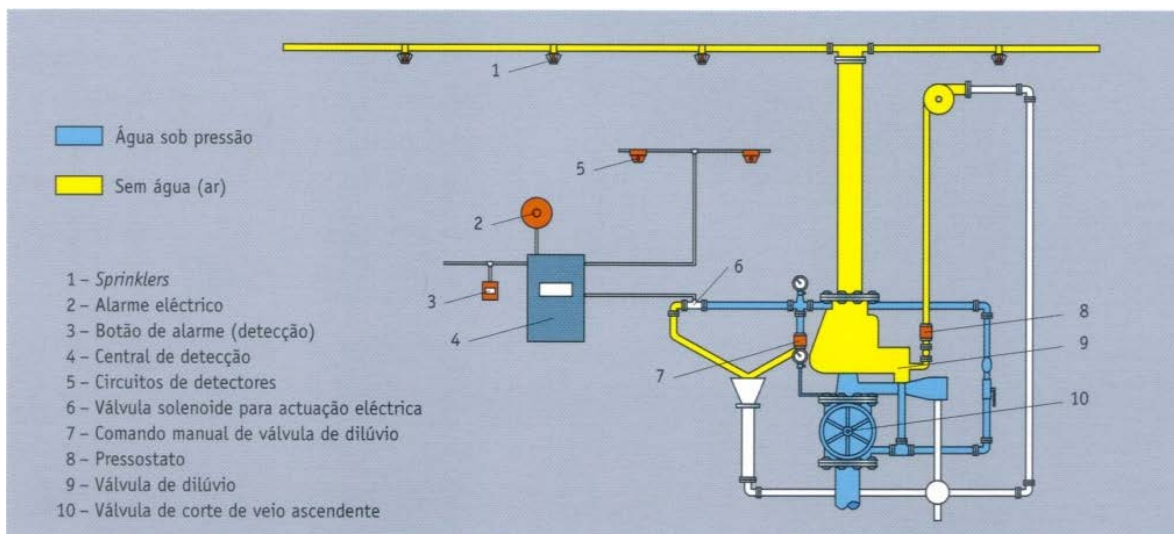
Instalação de sprinklers de pré-ação (preaction) [4].
